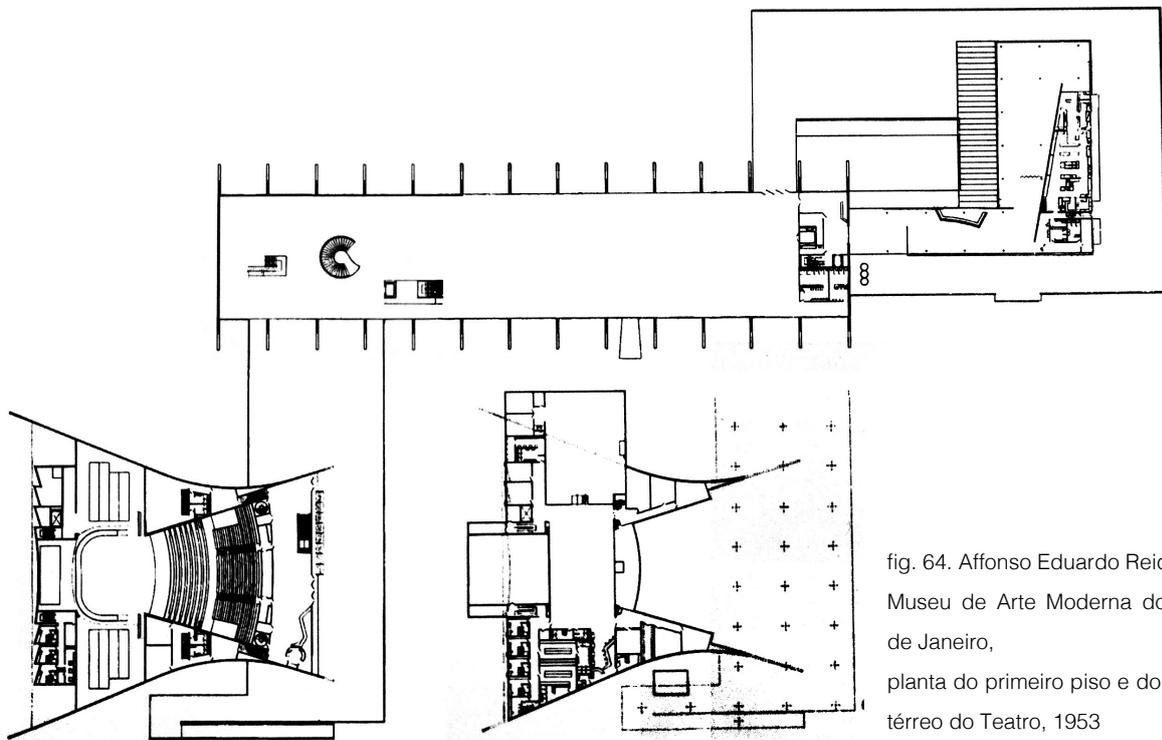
Affonso Eduardo Reidy, Museu de Arte Moderna do Rio de Janeiro, planta do primeiro piso e do piso térreo do Teatro, 1953
